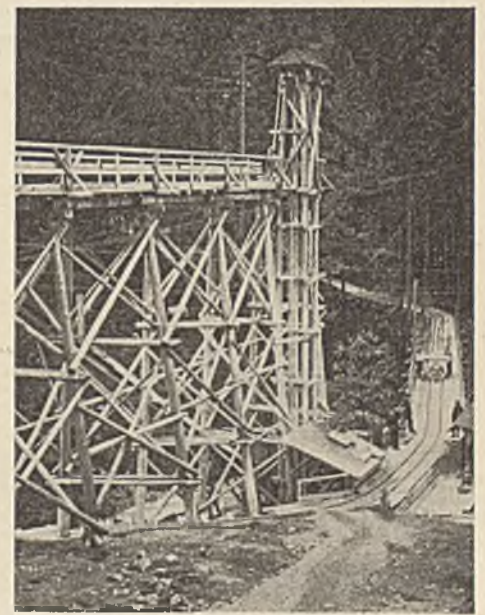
Gerüstbrücken mit Betonbereitungsanlage im „Kalten Graben“.
